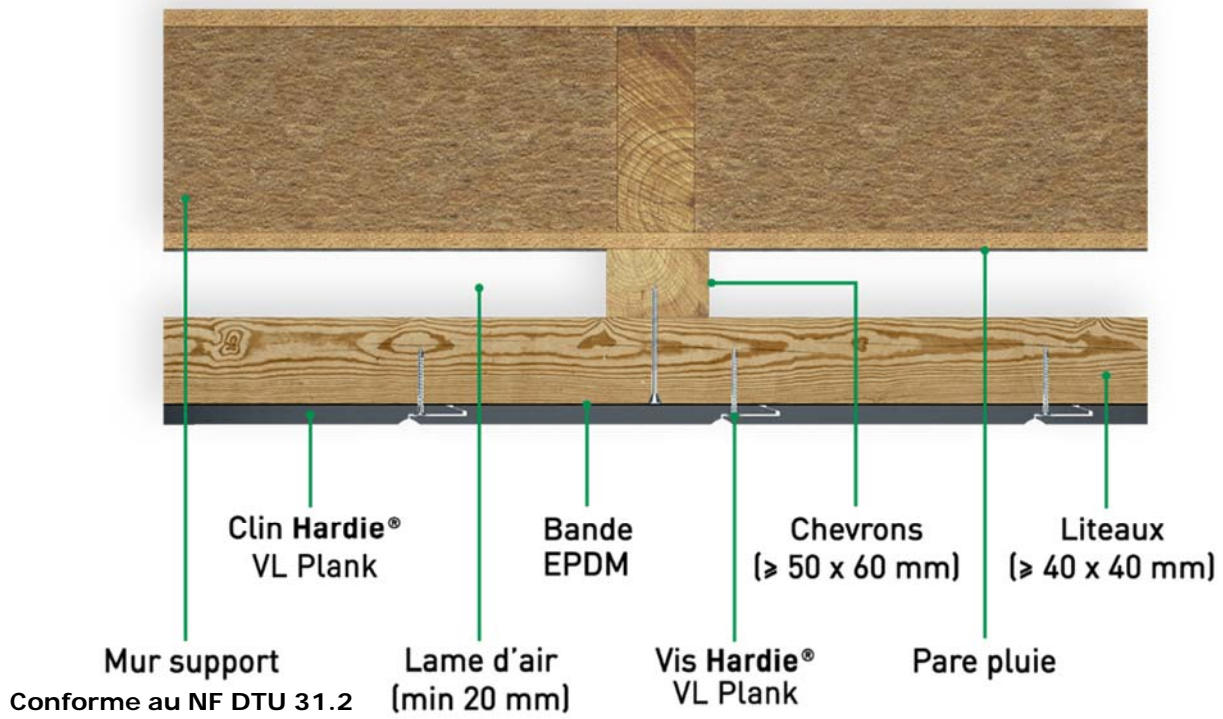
Coupe sur COB coupe verticale (pose horizontale des clins)
